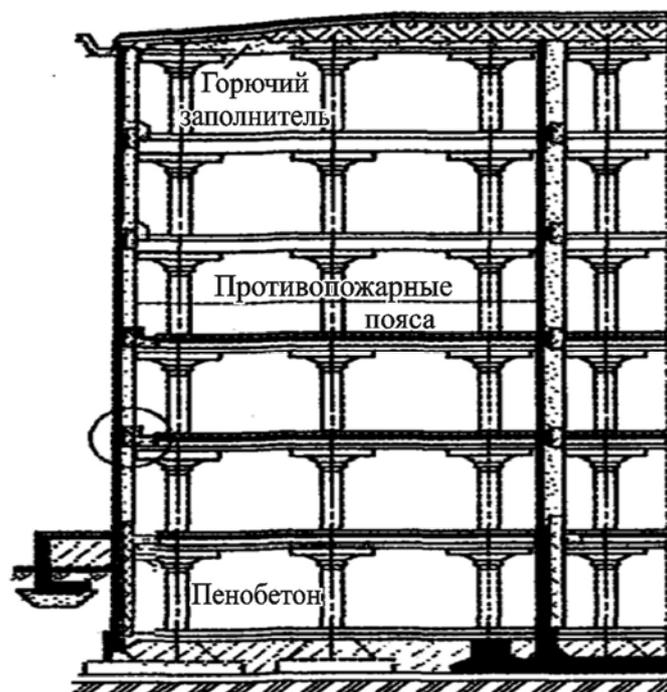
Устройство противопожарных поясов у наружной и внутренних стен холодильника
